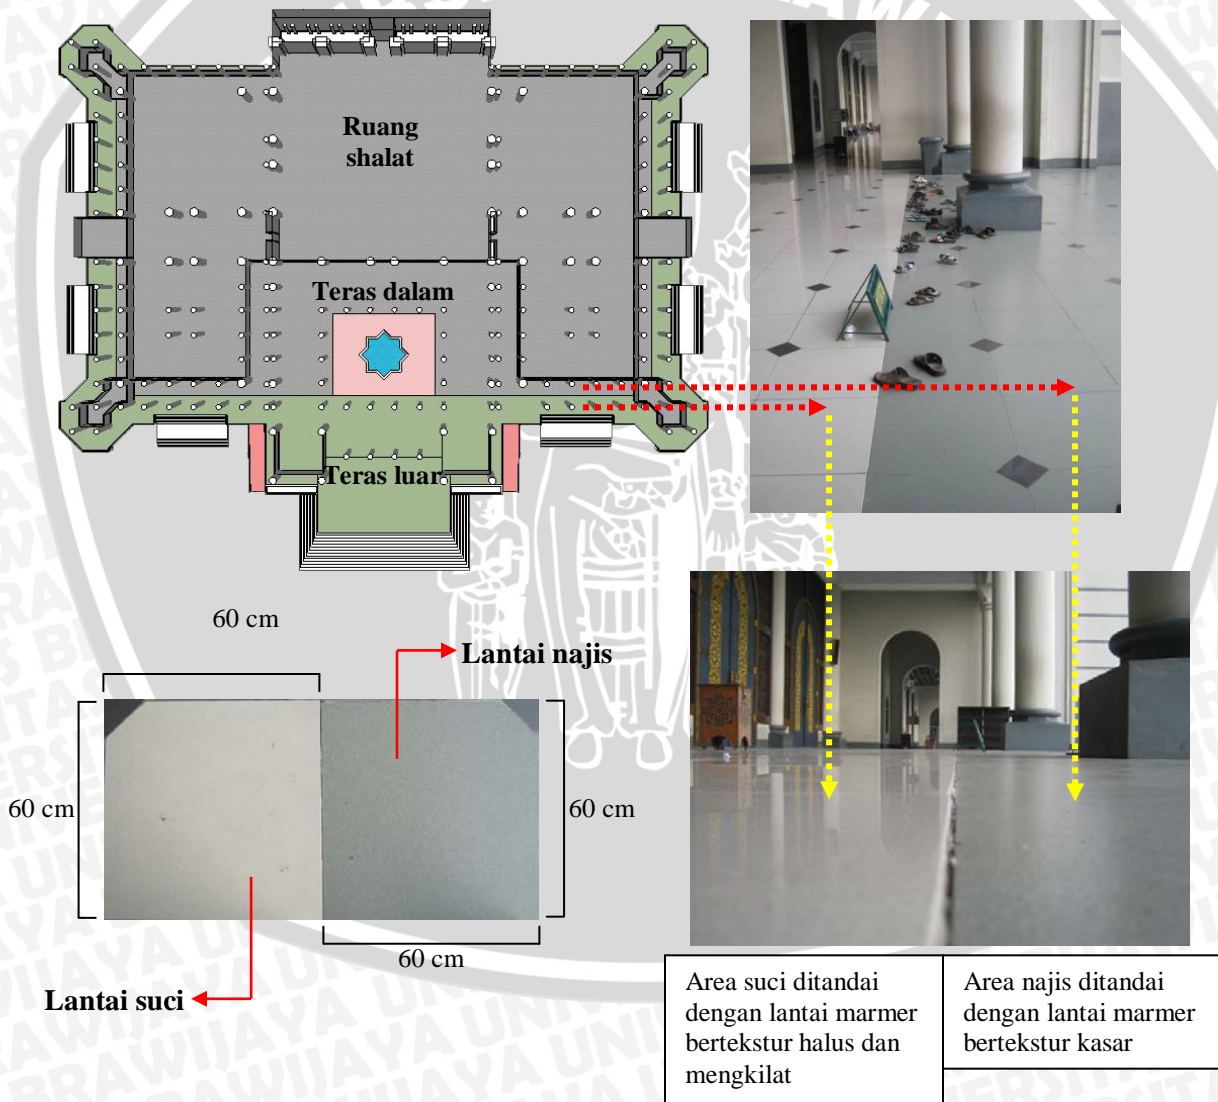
Perbedaan lantai suci dan lantai najis
